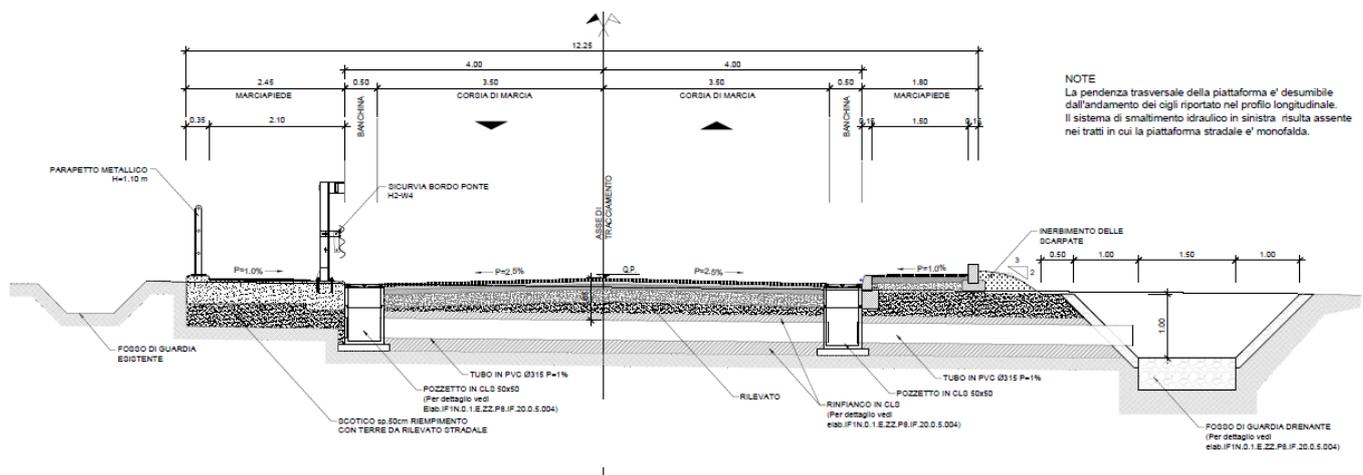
Sezione e pianta tipo tratto da km 0+000 a km 0+110
